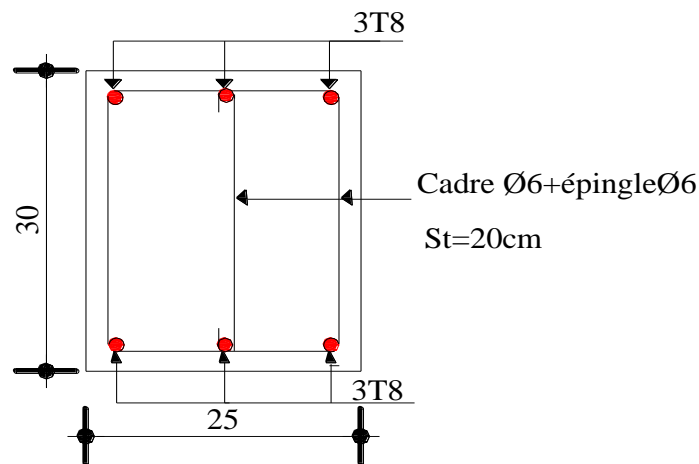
Schéma de ferrailage de la poutre de chaînage.
